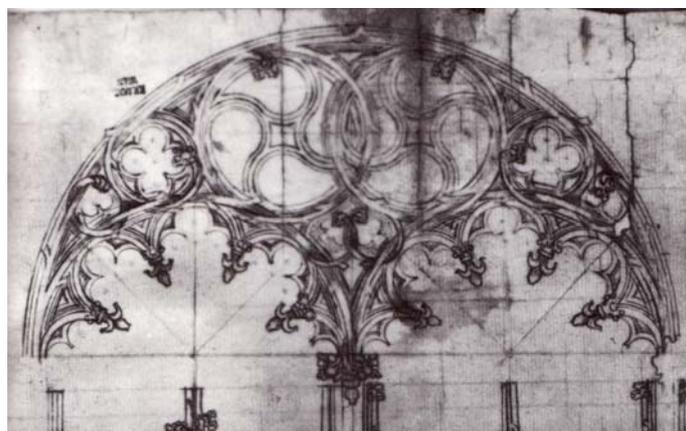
Madern Gerthener zugeschrieben: Riss des hängenden Maßwerks mit
